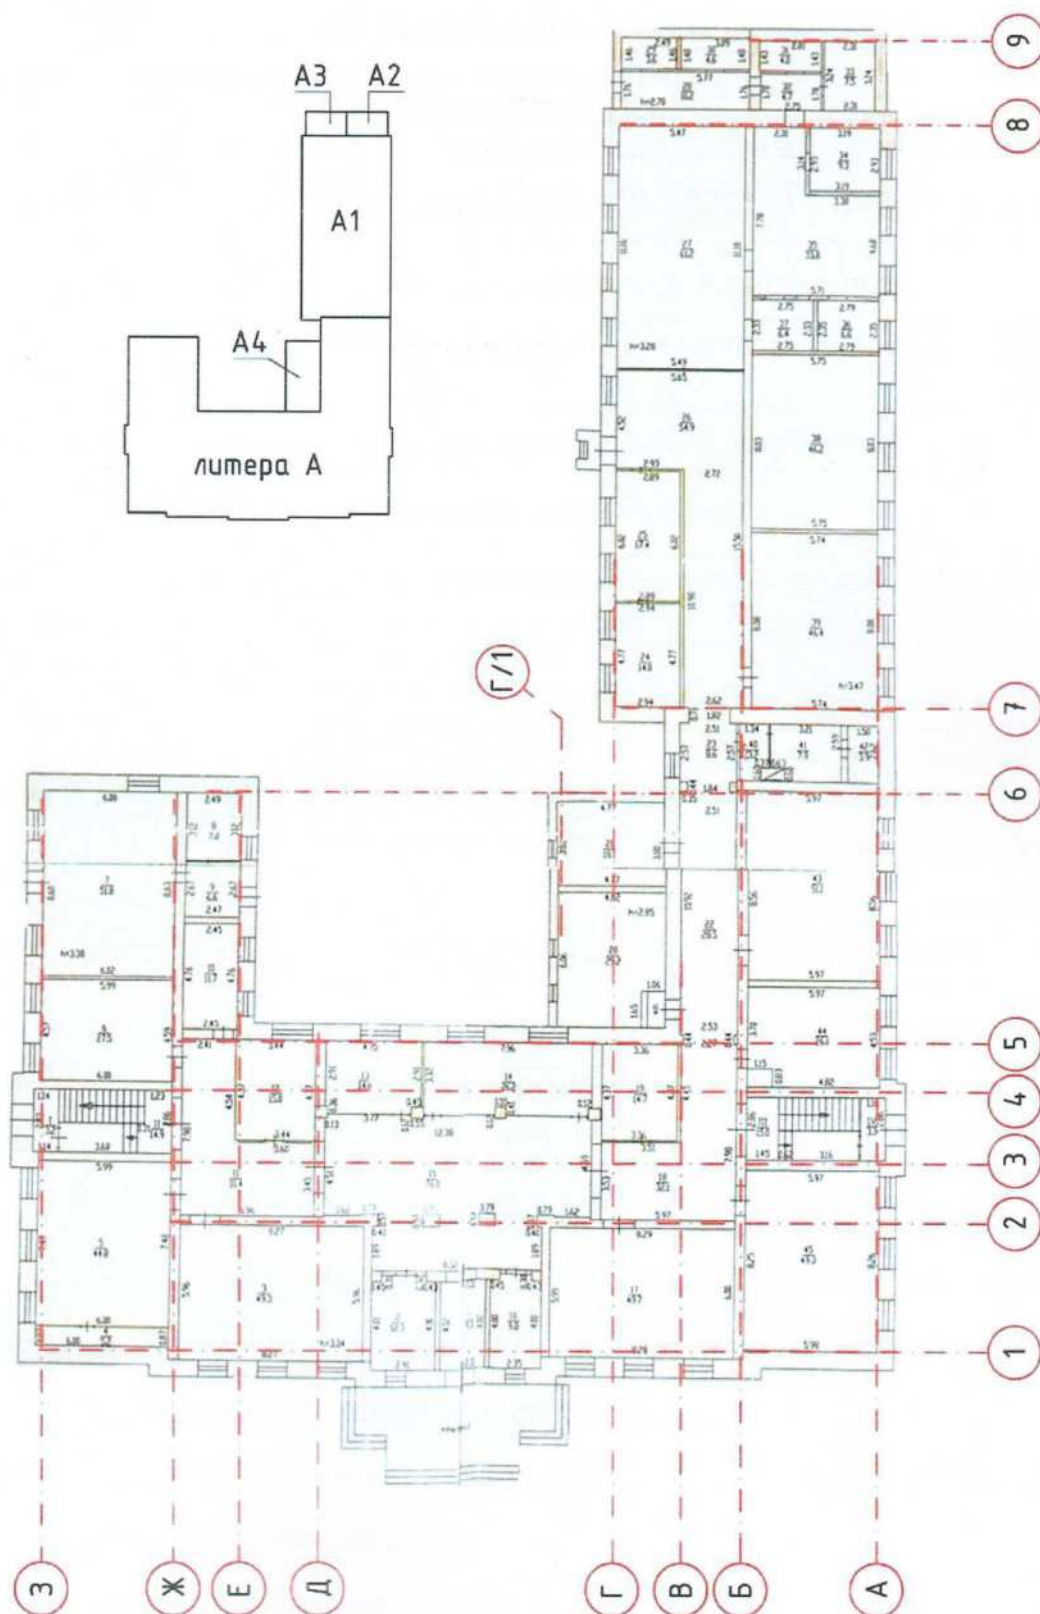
План 1-го этажа и схема частей (литер) здания школы
